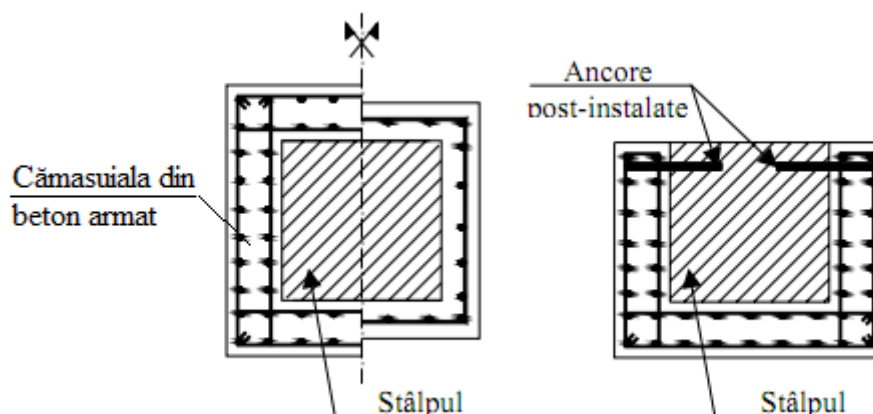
Cămășuirea stâlpilor cu beton armat
